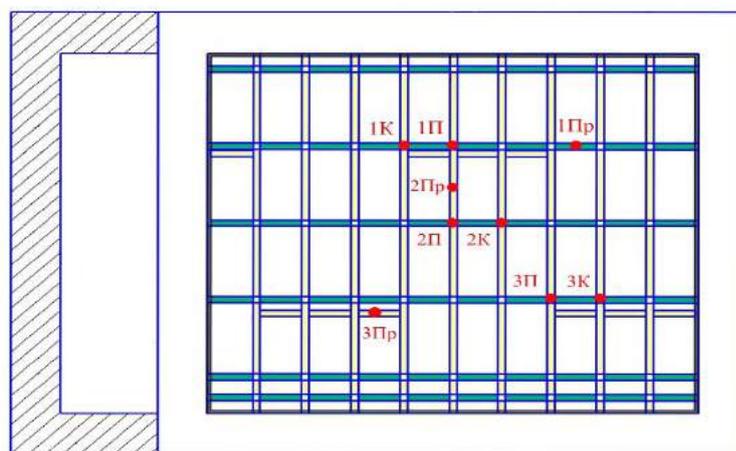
Схема расстановки ТЭП на профилях двухуровневого каркаса и соединительных элементах конструкции
